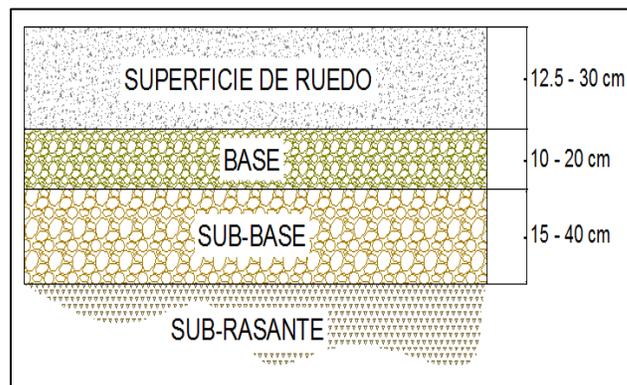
Estructura del pavimento rígido (Autor, 2013).
